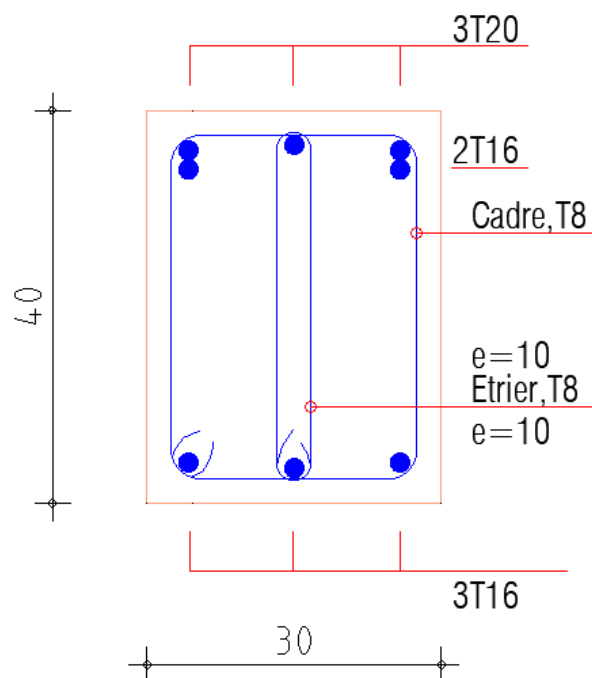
Ferrailage de poutre principale RDC → 7ème (appui).
